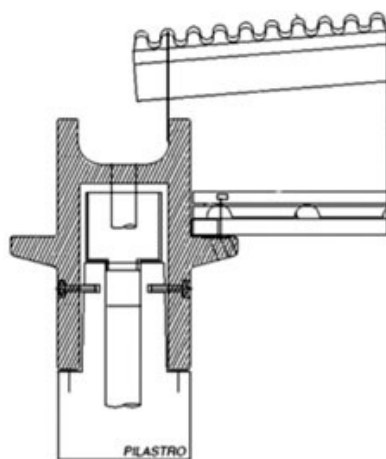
Sistema di collegamento tra la copertura, la trave canale e il pilastro.
